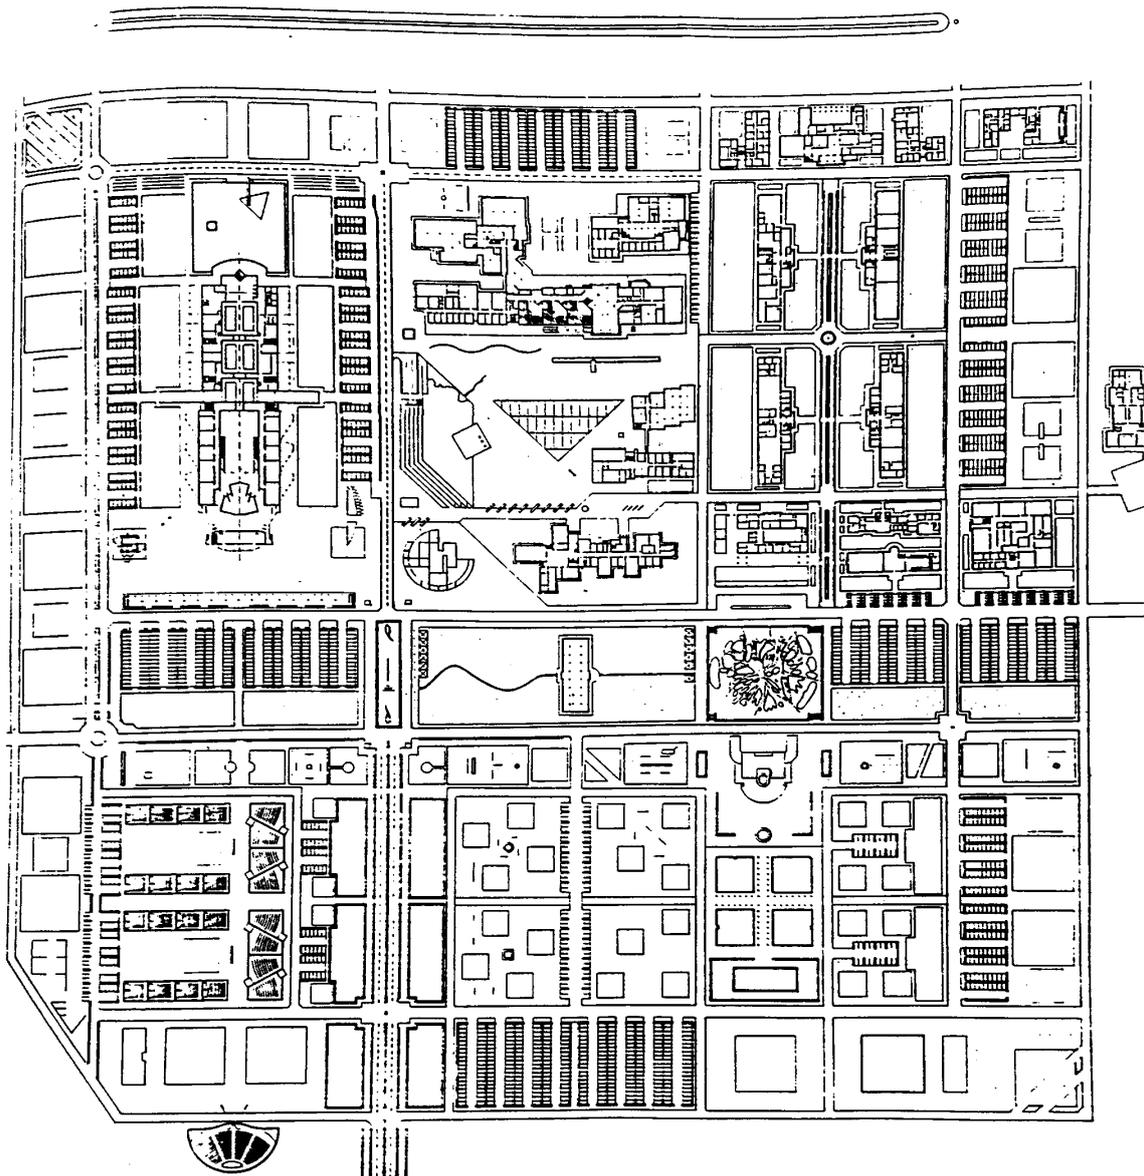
Plano de la propuesta del Plan Especial de San Vicente del Raspeig: E. Giménez.
